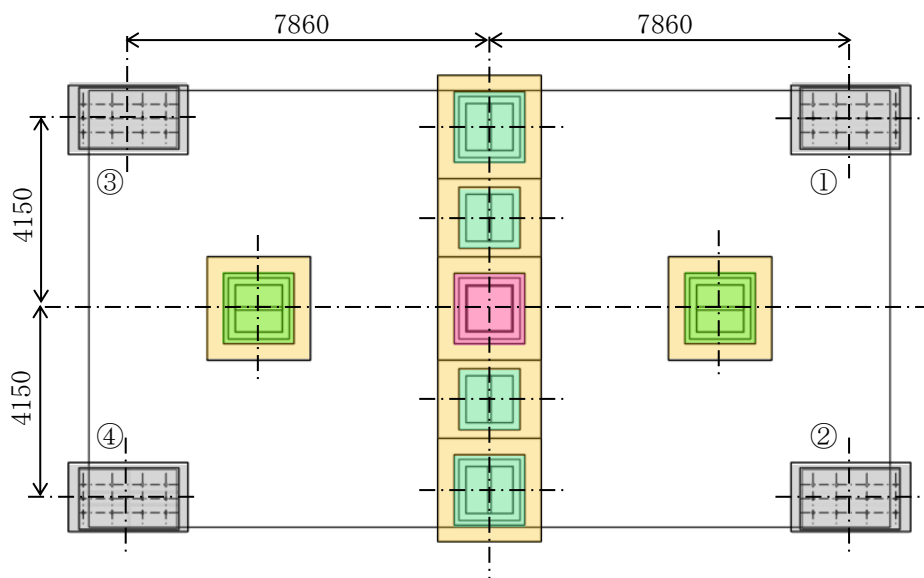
鉛直下向き荷重を受ける復水器基礎台配置図 (平面図)
